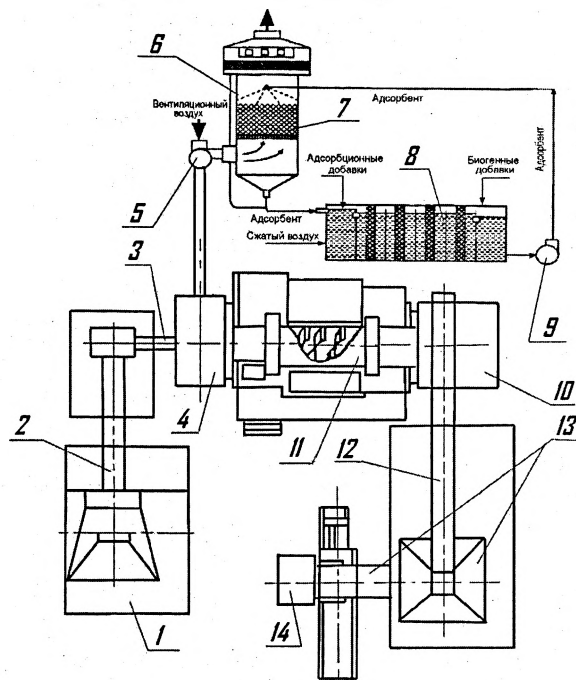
Устройство для подготовки алюминиевой стружки: 1- приемный бункер; 2 - конвейер скребковый (загрузки); 3 - питатель лотковый инерционный; 4 - камера загрузки; 5 - вентилятор; 6 - абсорбер; 7 - массообменная решетка; 8 - биореактор; 9 - насос; 10 - точка; 11 - барабан сушильный; 12 - конвейер скребковый (выгрузки); 13 - шкаф управления; 14 - тара
